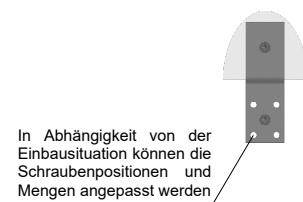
Massive Deckenkonstruktion - Batterie - Einbaurahmen E1
